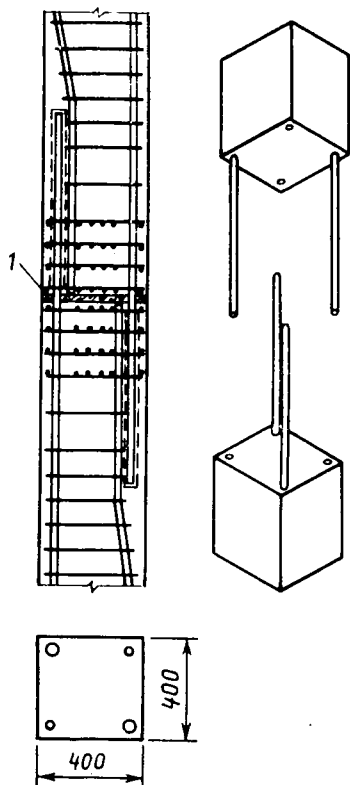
Штепсельный стык колонн с расположенными в шахматном порядке выпусками продольной арматуры
